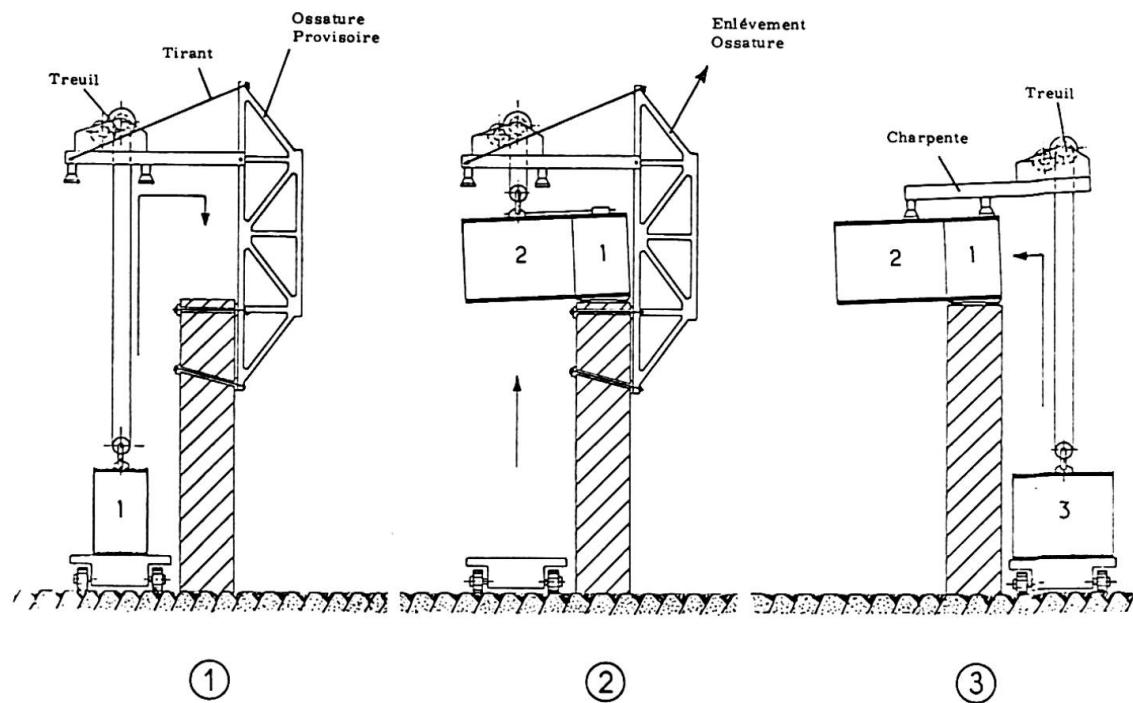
POSE DU VOUSSOIR DE PILE DANS LE LEVAGE PAR TREUILS
